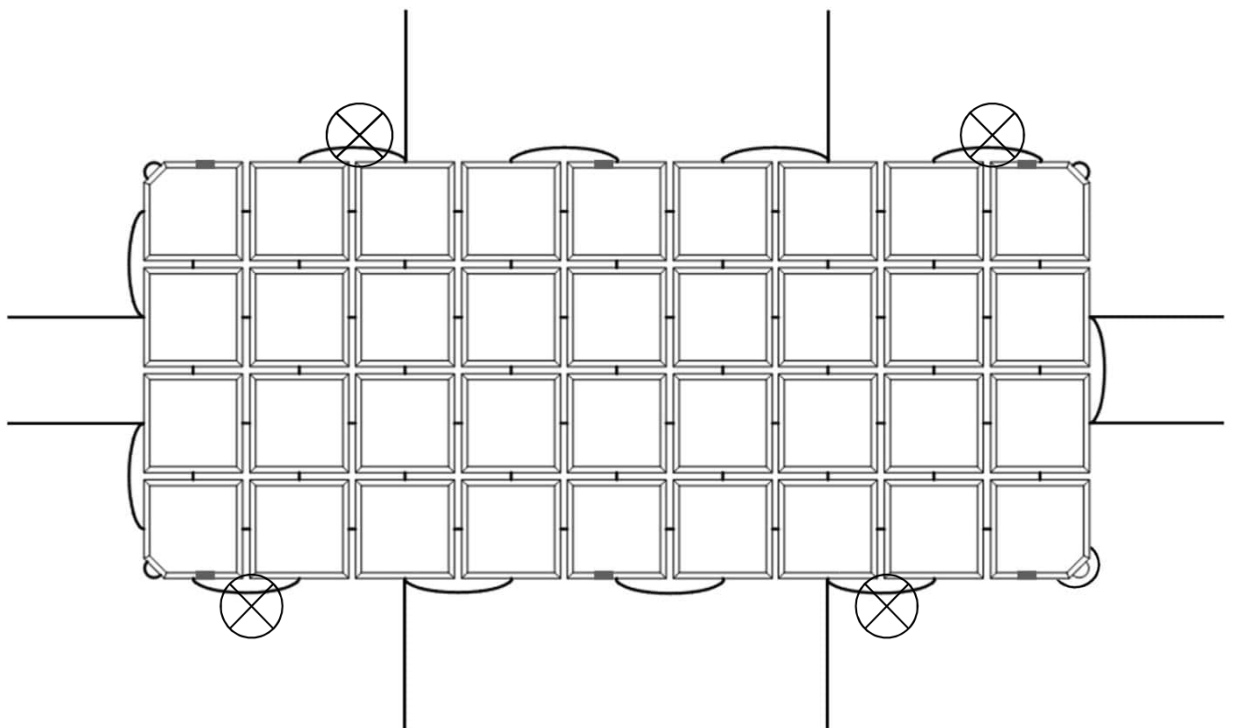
Места строповки гибкой бетонной плиты за четыре петли
